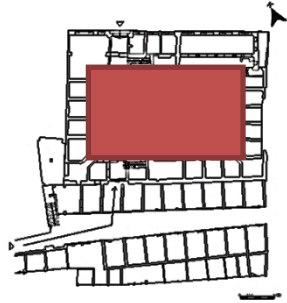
Güneydoğu Anadolu Bölgesi Tek Avlulu Han Planı Örnekleri (Yapı planları Yazar Arşivi, 2022-2023)
